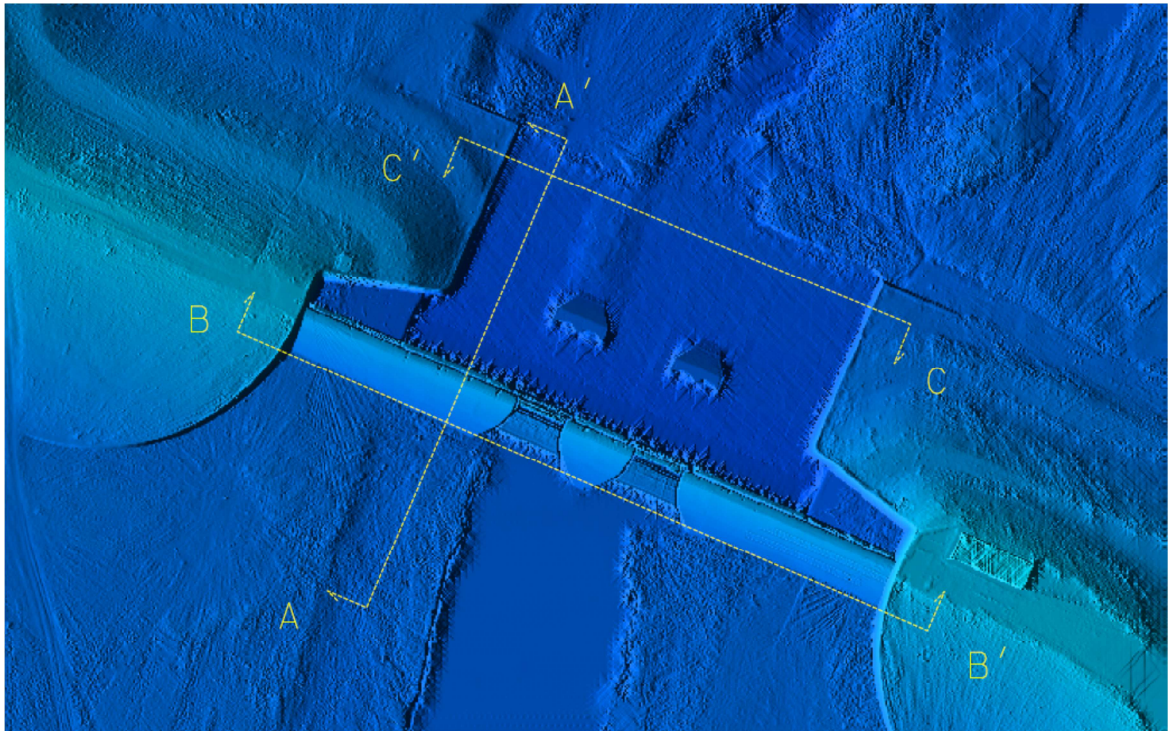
ubicazione planimetrica della sez. A-A' del manufatto
